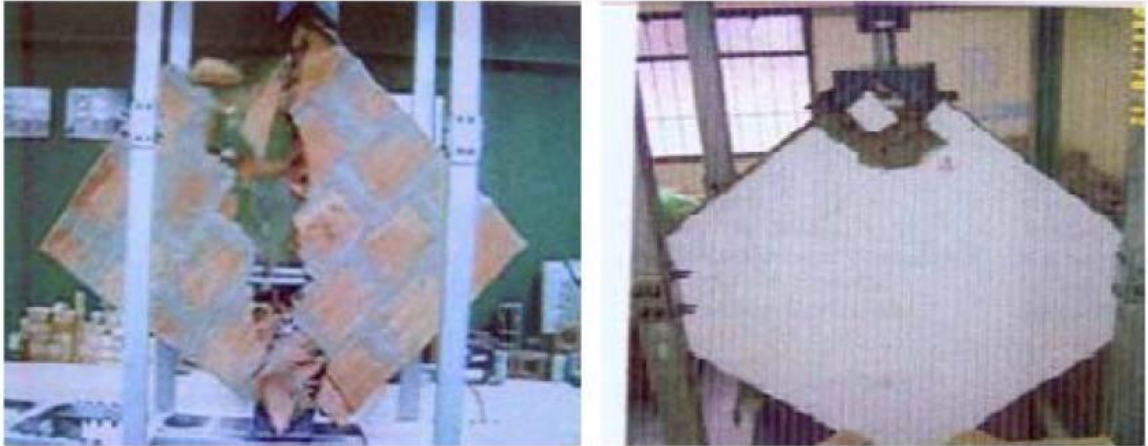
Comportamiento de un muro de mampostería no estructural sin refuerzo; Imagen 3.2.1-8. Comportamiento de un muro de mampostería con refuerzo de malla electrosoldada. Fuente: MOLANO, M. y SERRANO, A. Rehabilitación sísmica de mampostería no estructural reforzada con listones de madera [Tesis de grado]. Bogotá, D.C.: Pontificia Universidad Javeriana, 2005.
